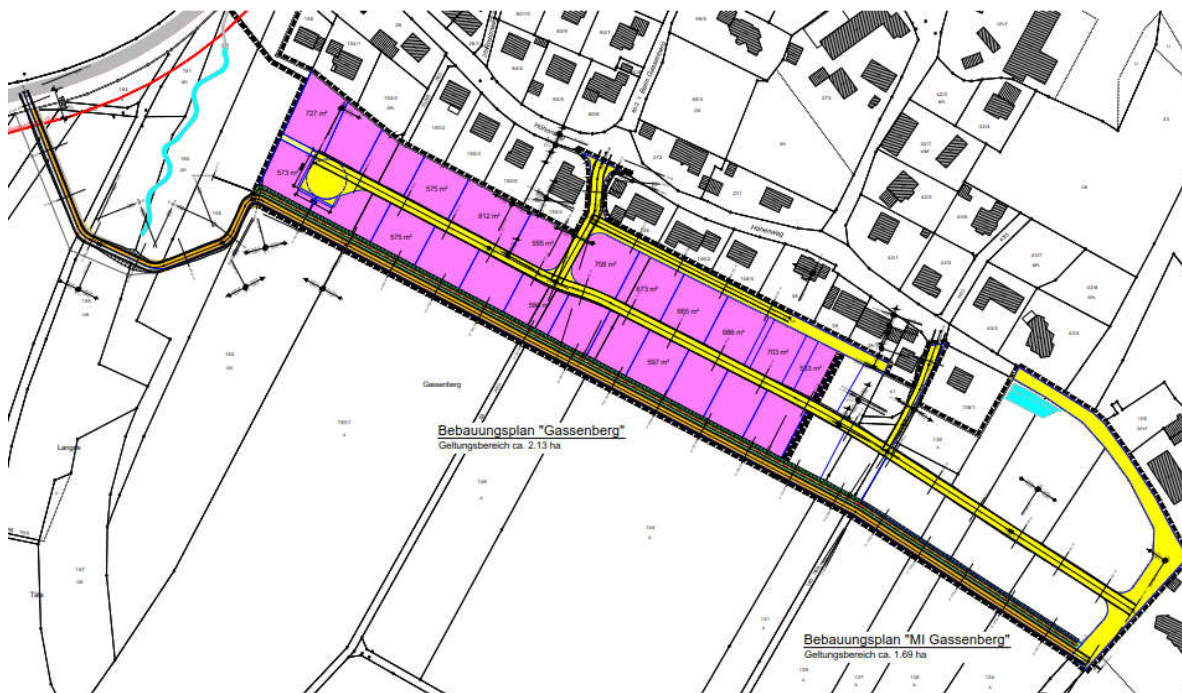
Lageplan mit Darstellung der drei Vorhabensbereiche
